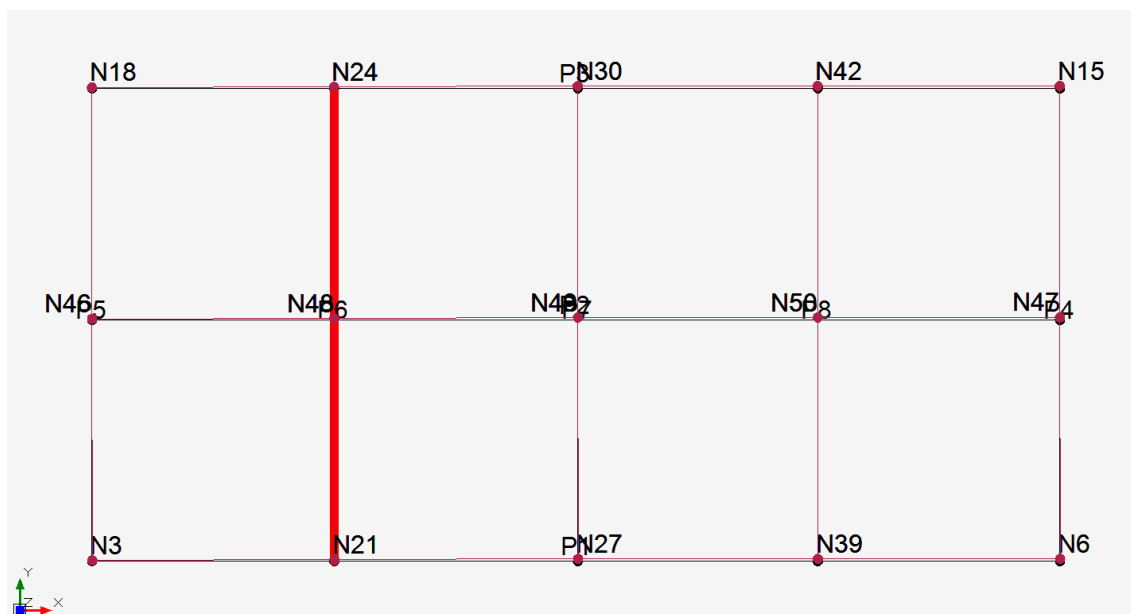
Pianta del fabbricato. In evidenza la parete 6, in direzione Y.
